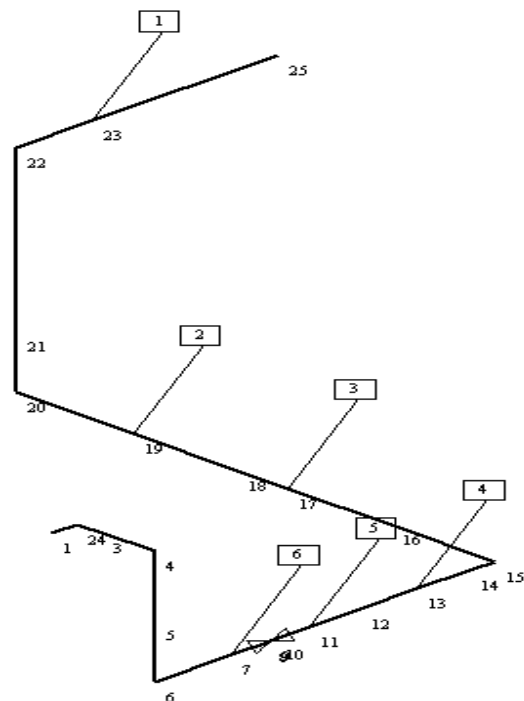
Аксонометрическая схема трубопровода всаса от КЭН-2 Ст. до ПНД-4 (1-25 – расчетные сечения, цифры в прямоугольниках – опоры и подвески)
